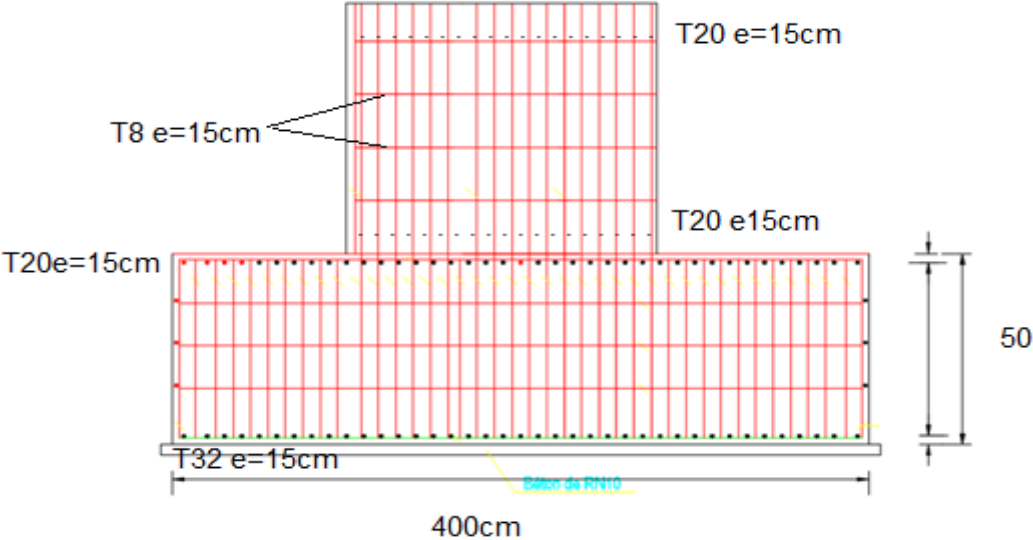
ferrailage fondation d'appuis d'escaliers coté A
